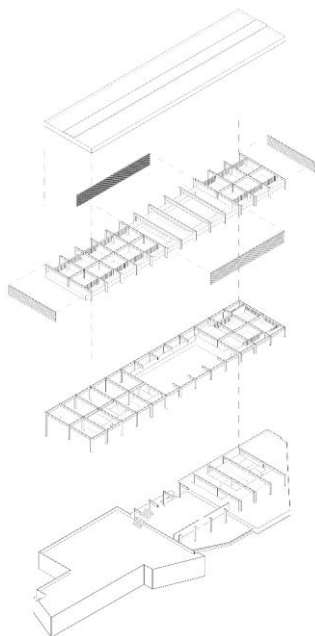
Perspectiva explodida isométrica. Vê-se o térreo (1º pav.), 2º pav. com adição e subtração de volume e 3º pavimento com adição de cobertura
